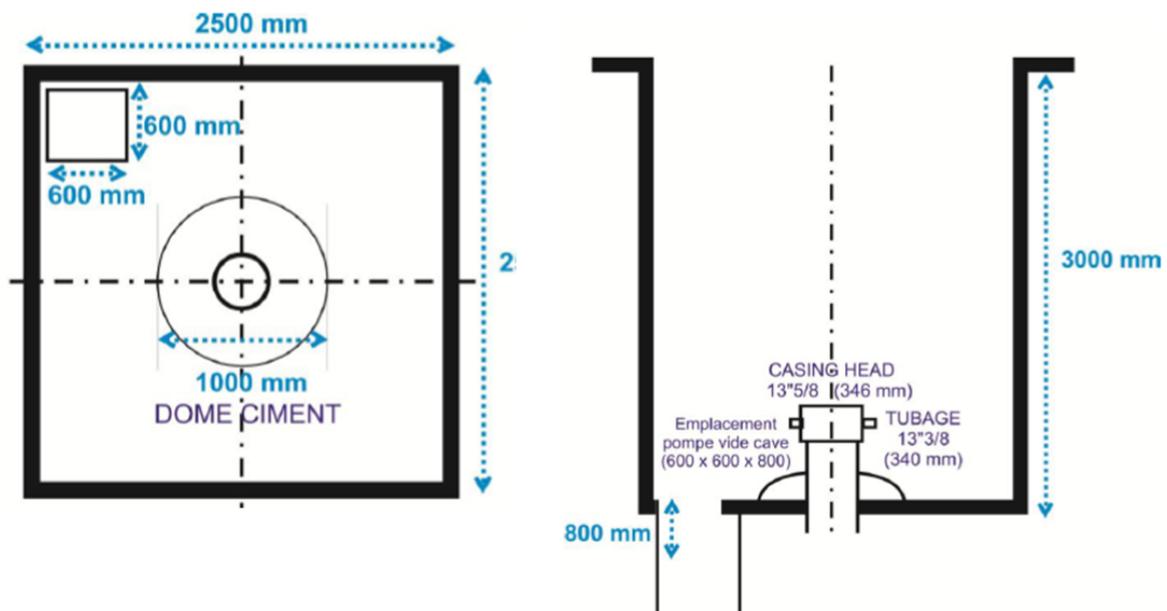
Plan de génie civil type d'une cave standard (un seul puits)
